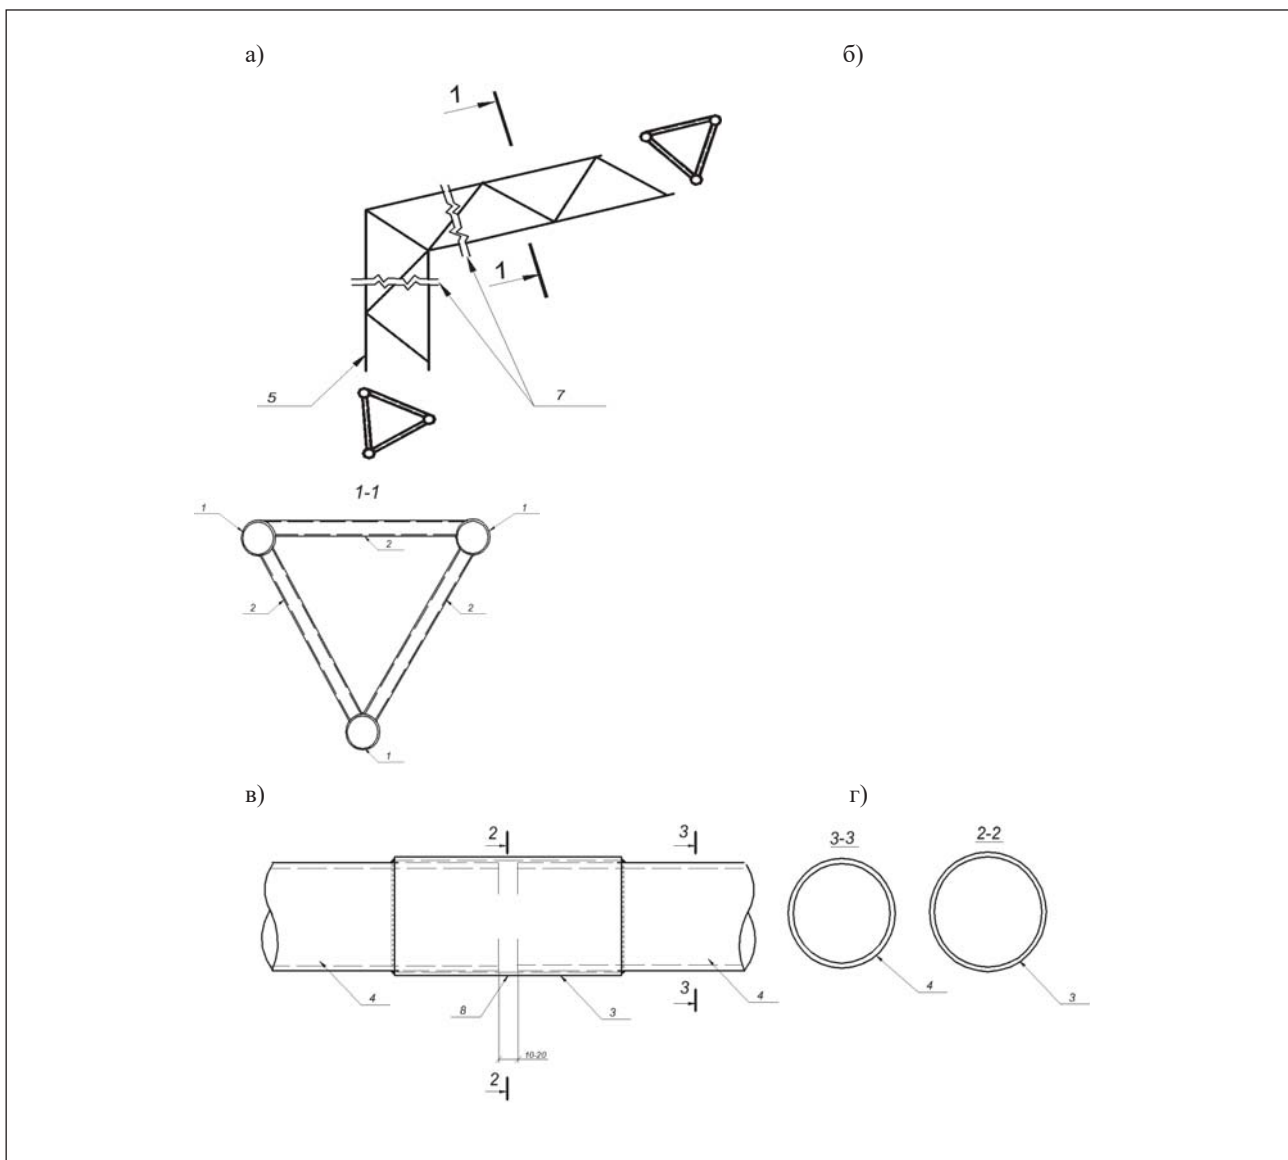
Карнизний монтажний вузол металеві рами з просторовими елементами із круглих труб: а) загальна схема; б) розріз 1–1 (переріз просторового елемента ригеля); в) схема монтажного елемента карнизного вузла; г) умовний монтажний зварний стик круглих труб за допомогою обійми
